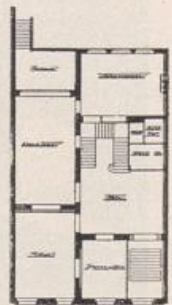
Tonhallenstrasse 11. Erdgeschoss.
